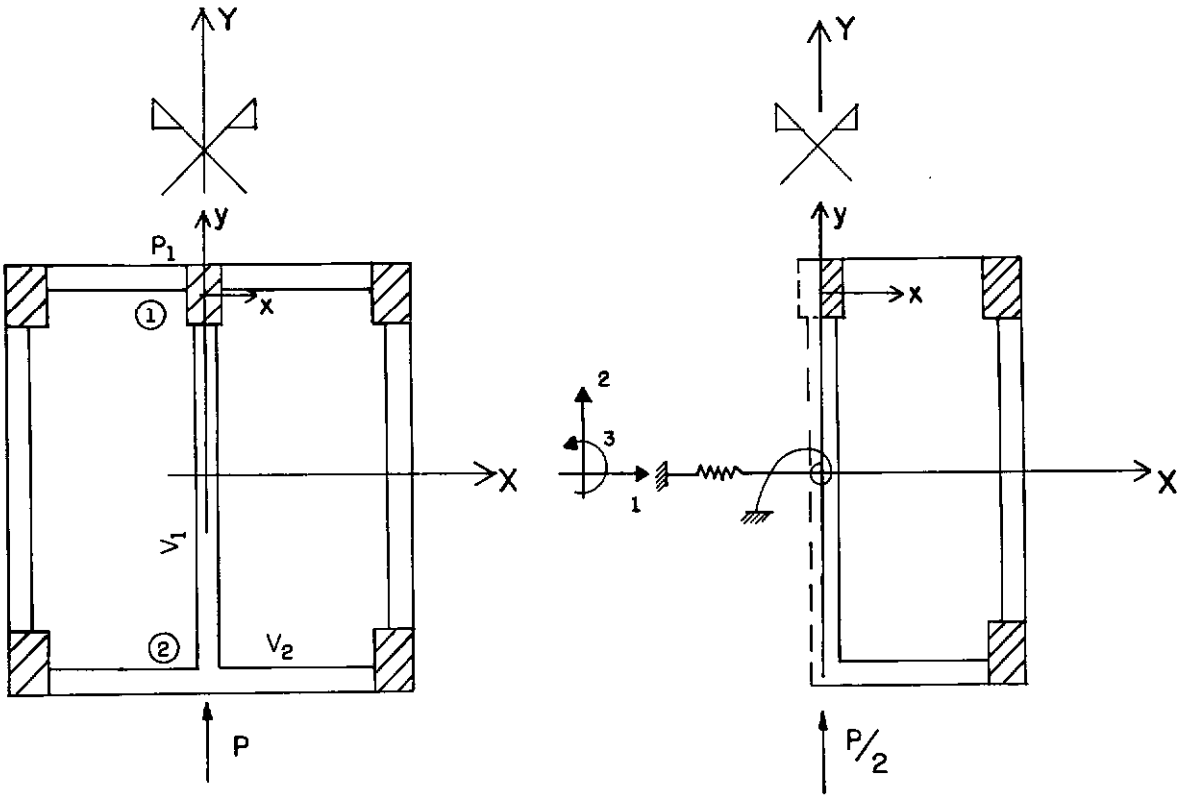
Exemplo de aplicação de apoios elásticos de andar
